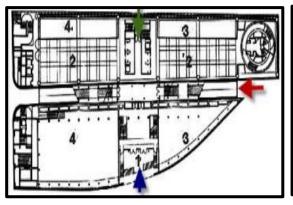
plan de Rez de chaussé. Source :Menadi, 2015.
